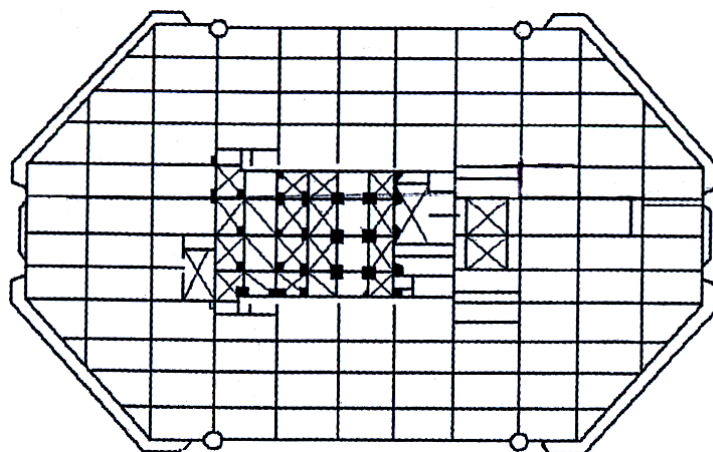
План 44 -этажного административного здания с трубобетонными колоннами в г. Сиэтле [1]
